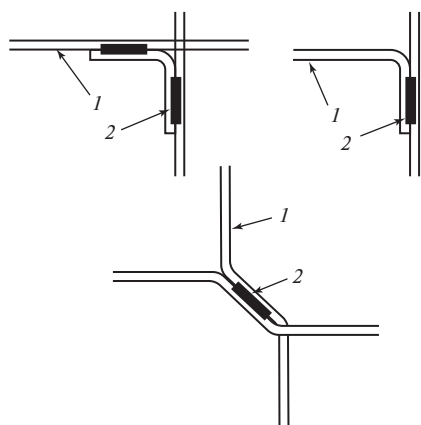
Выполнение сварных соединений арматуры железобетонных конструкций:
